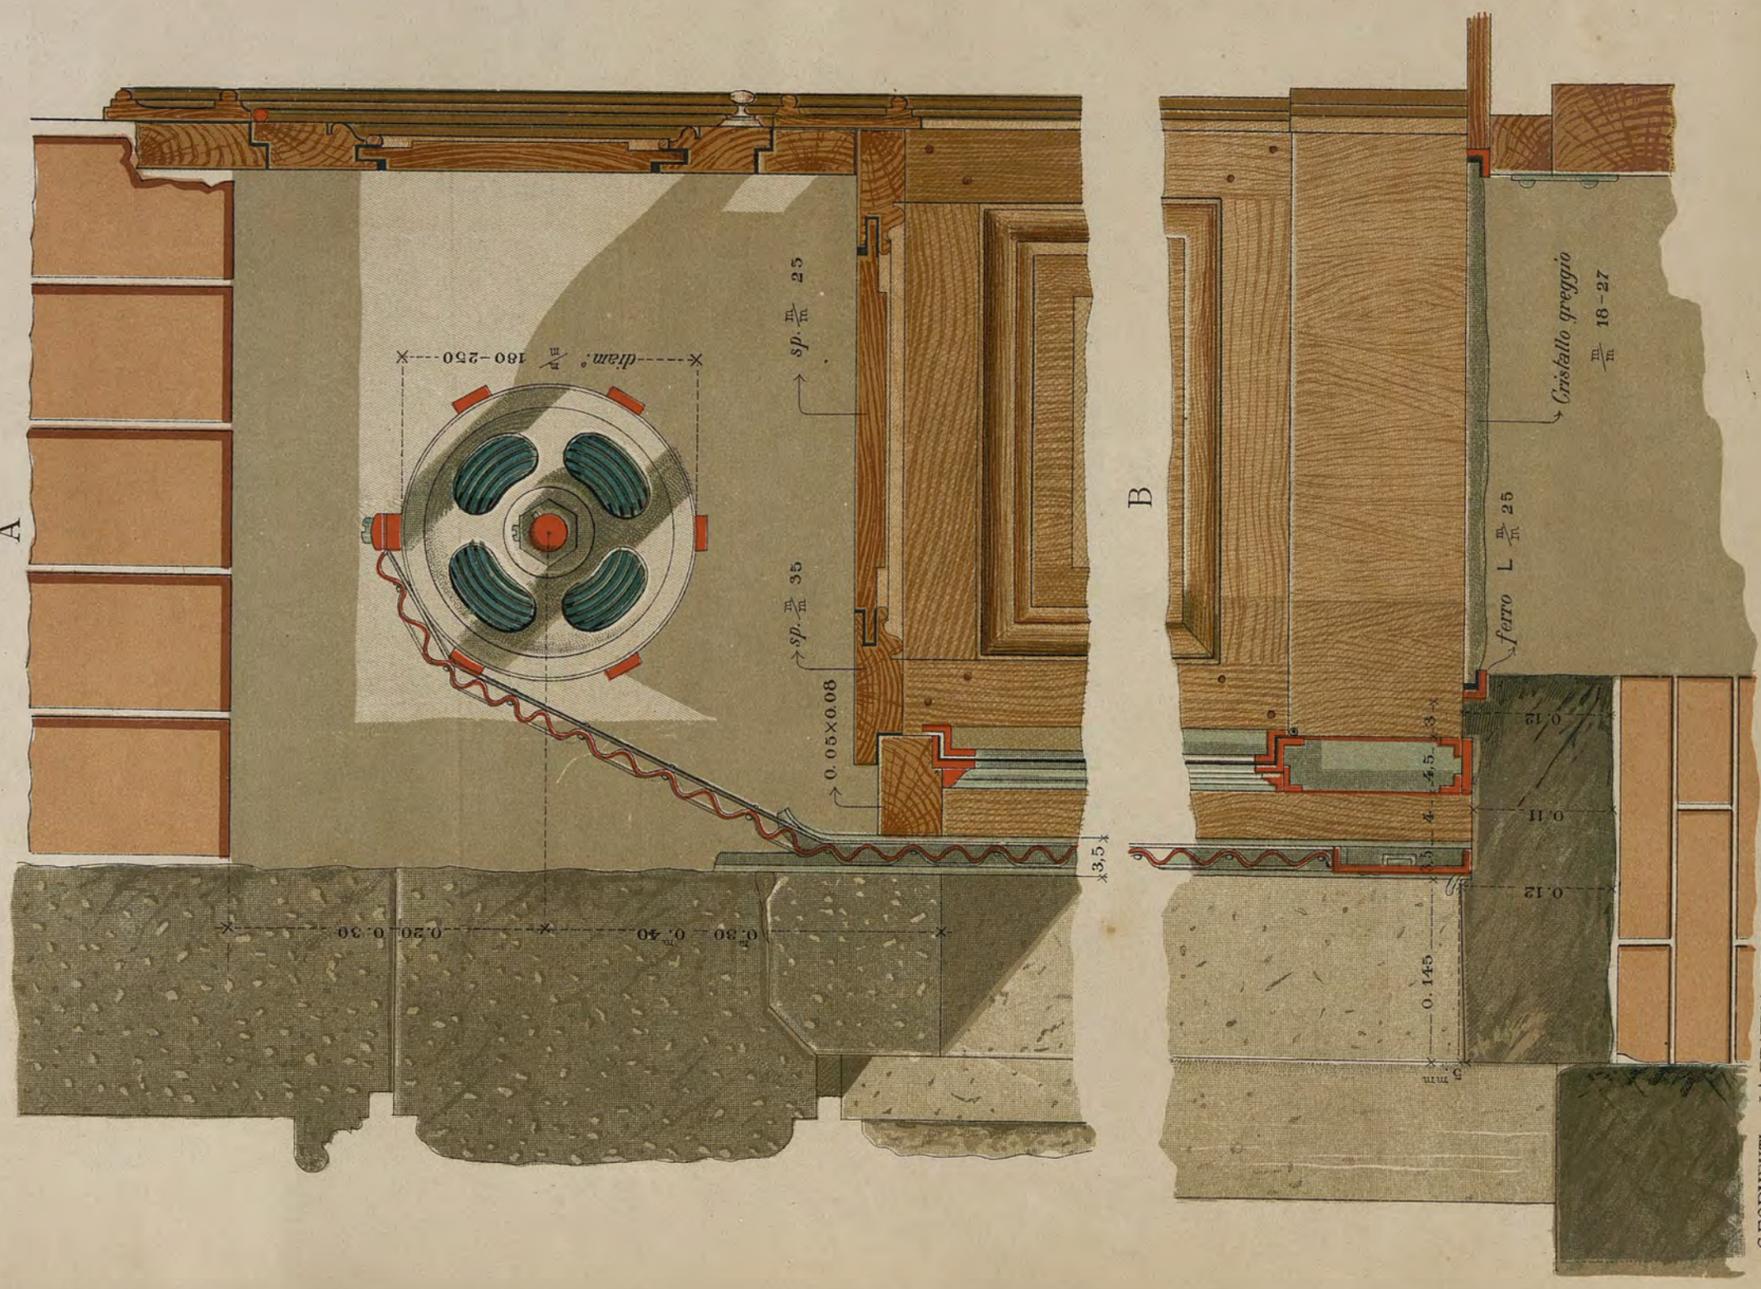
Una porzione dell'imposta della fig. 1. vista dall'interno
